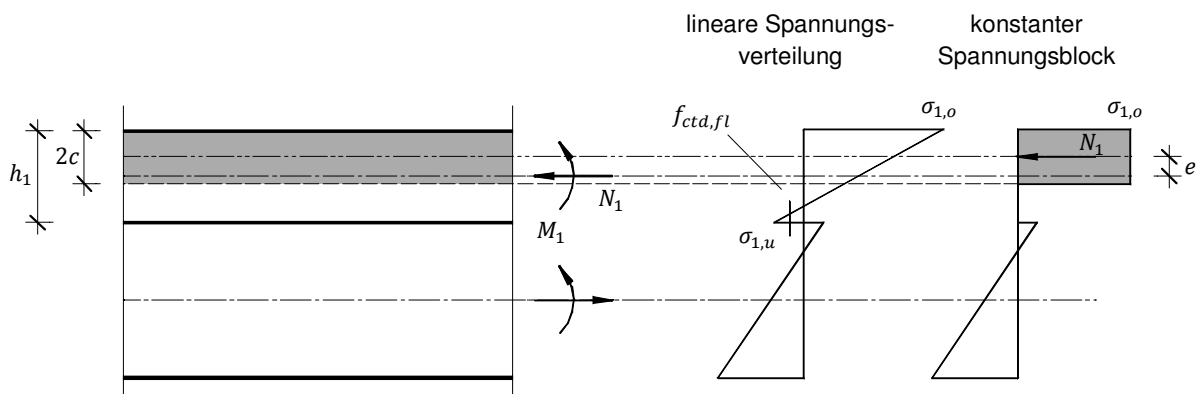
Gerissene Betonzugzone – lokale Spannungsumlagerung
